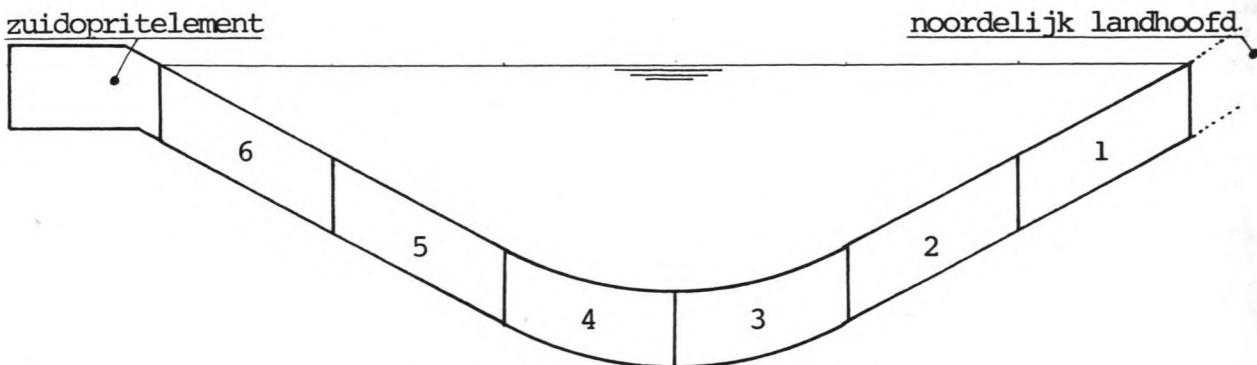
Langsdoorsnede van de tunnel met de zeven af te zinken tunnelementen.
